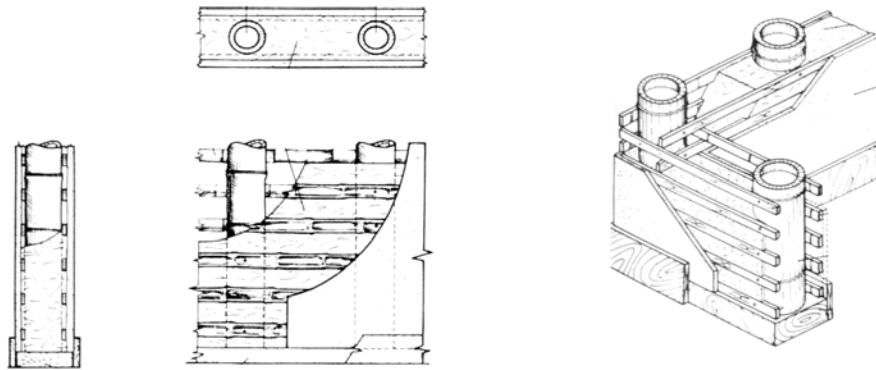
Detalhes construtivos dos painéis preenchidos com barro (LÓPEZ, 2003, p. 239).
